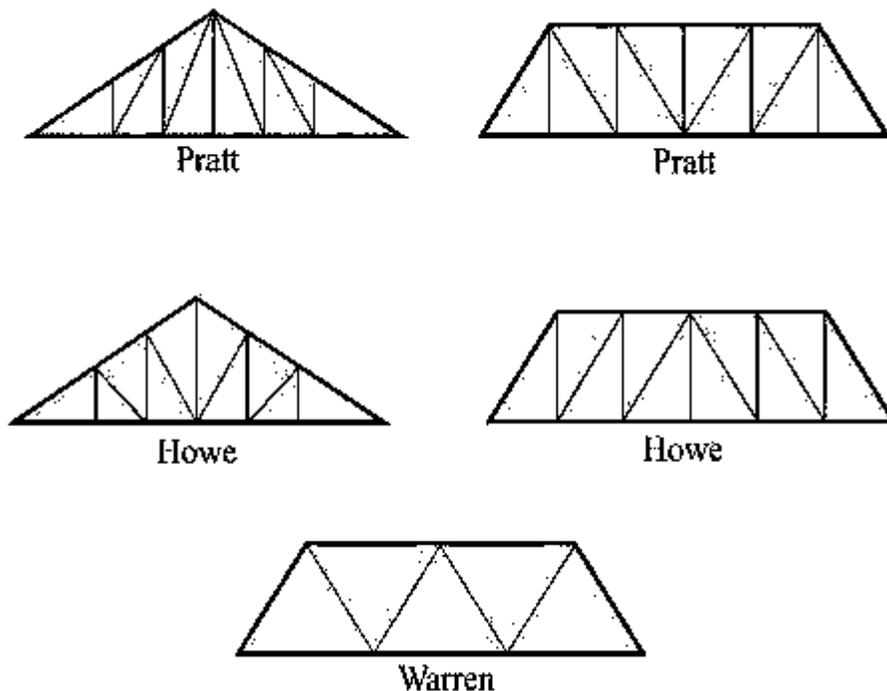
Tipos de armaduras. En la figura se muestra el tipo de armadura Pratt, Howe y Warren.
